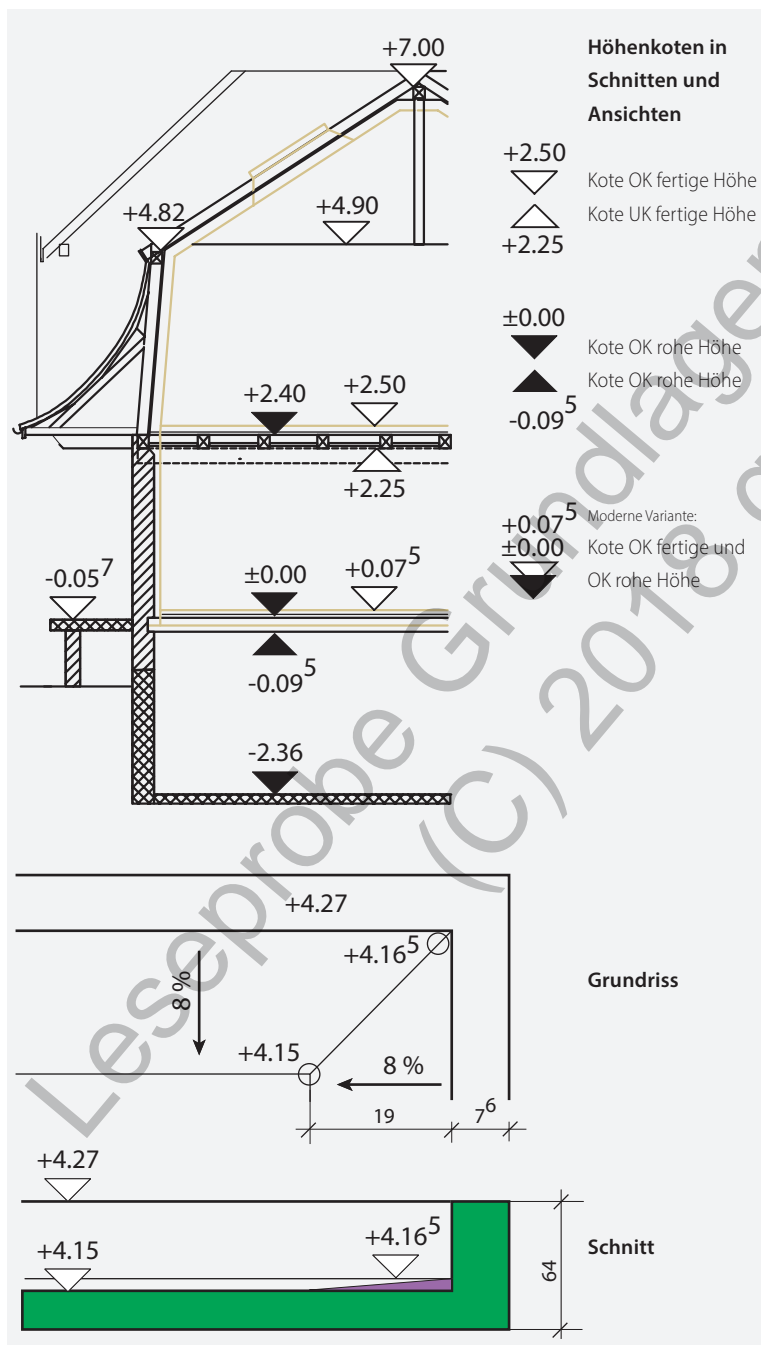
/510, 511: Darstellung der Höhenkoten in Grundrissen, Schnitten und Ansichten
